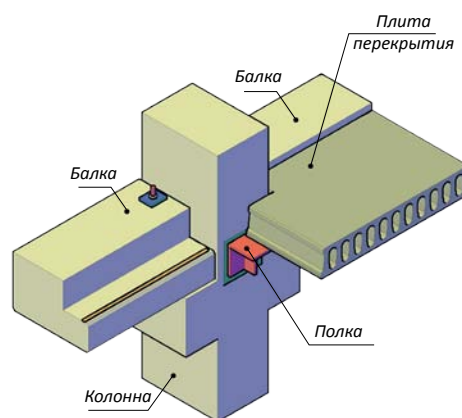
Опора многопустотного перекрытия на полку, установленную на колонну.
